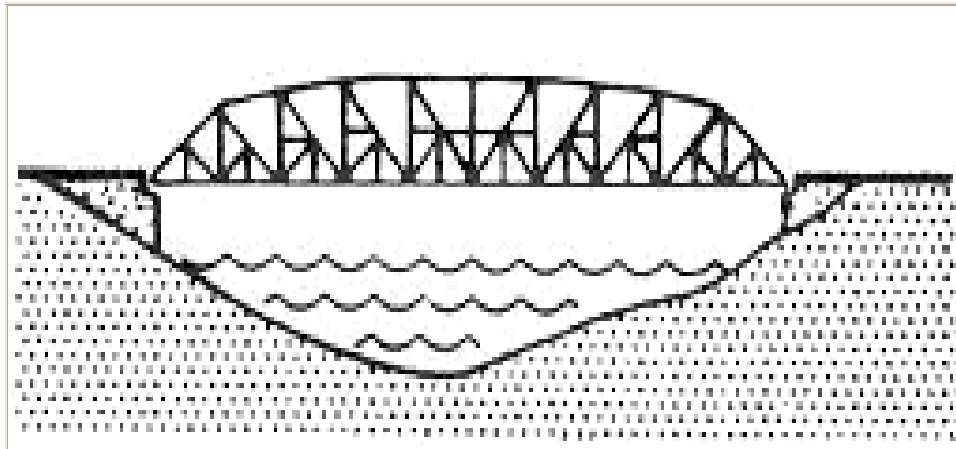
Imagen de un tipo de un puente de armadura sencilla.
